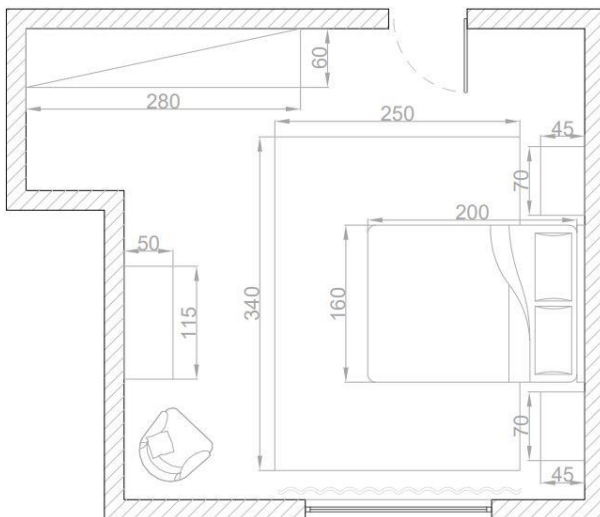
Planta de Equipamento Cotada Proposta 3 Suite Petra
